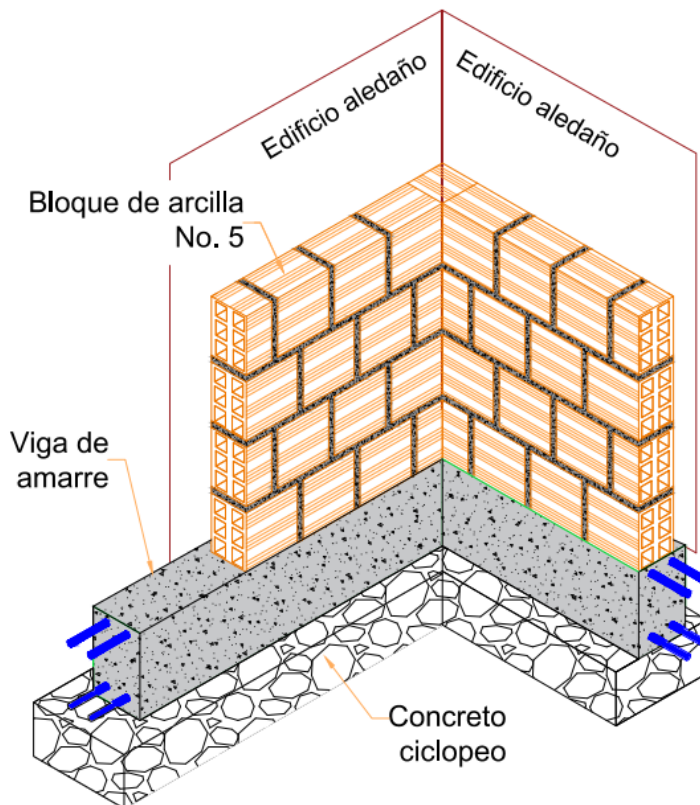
Detalle muro sin refuerzo. Fuente (Elaboración propia).
